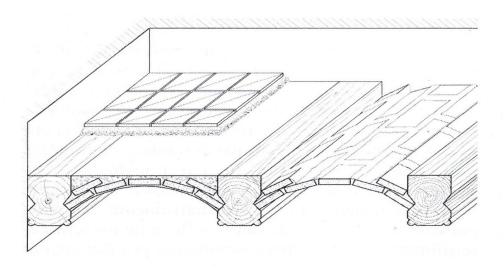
Interior forjado planta baja vivienda. Calle Rosario. (Pastor, R. 2016)
